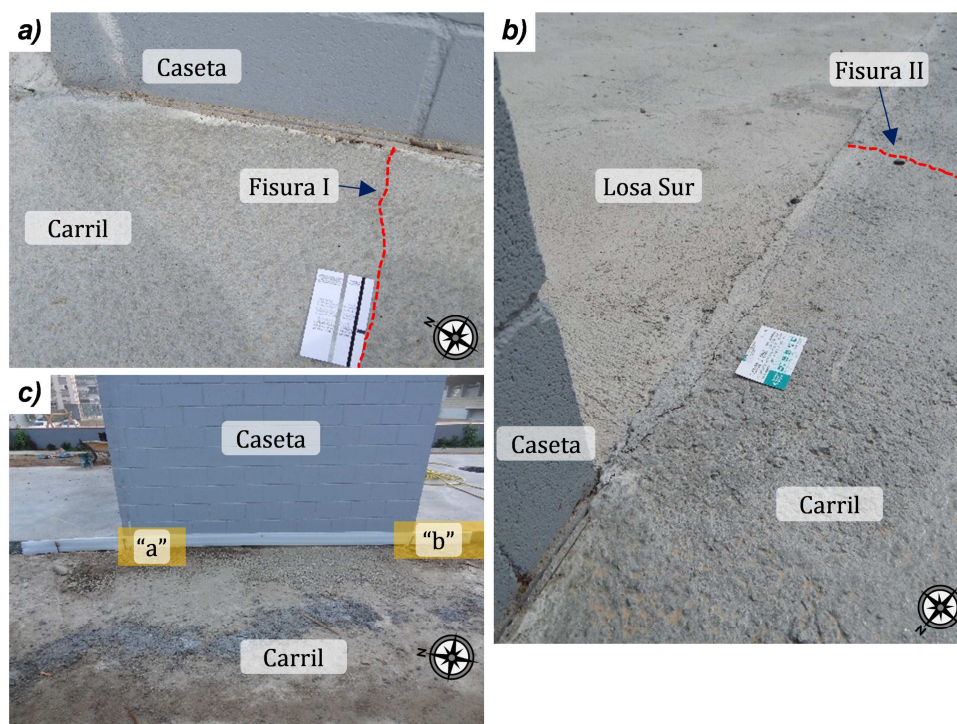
89 – a) localización fisura I; b) localización fisura II; c) vista general
